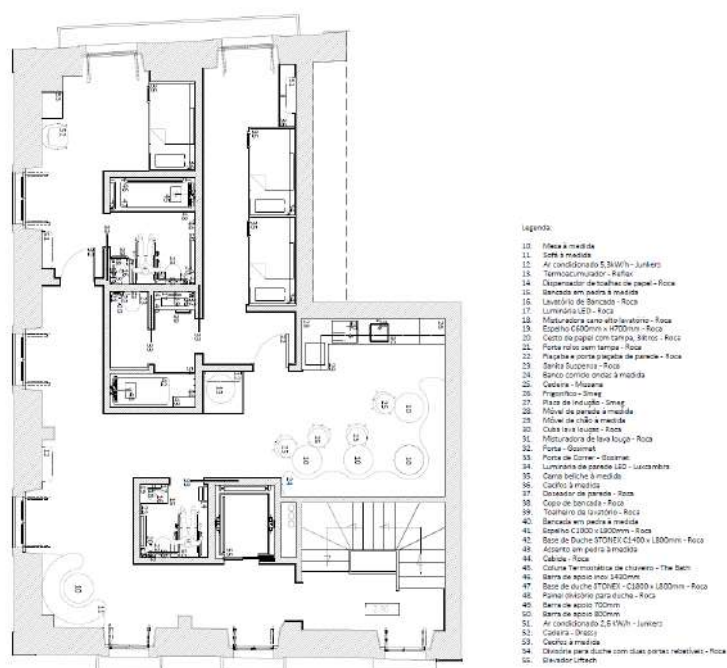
Planta de Mobiliário e Equipamento - Piso 1
